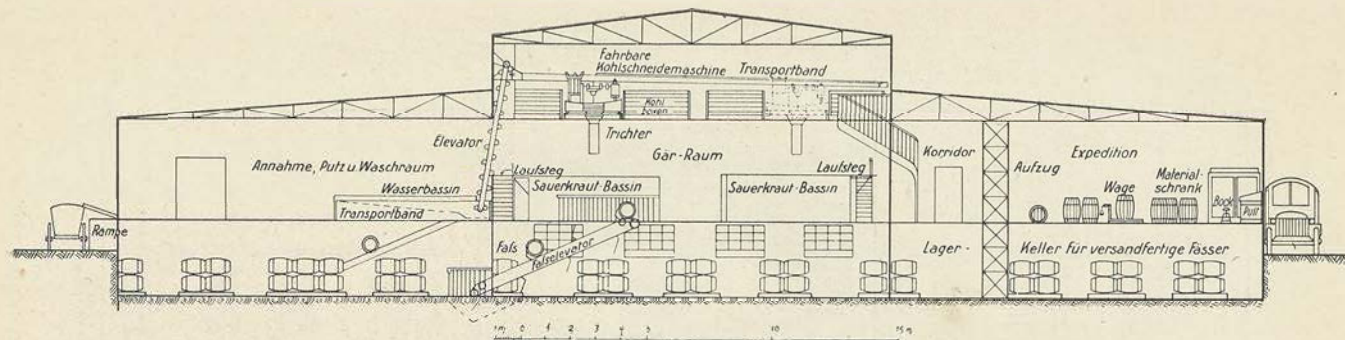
267. Entwurf für eine Sauerkrautfabrik. Entwurf Ed. Jacobsen, Hamburg.
